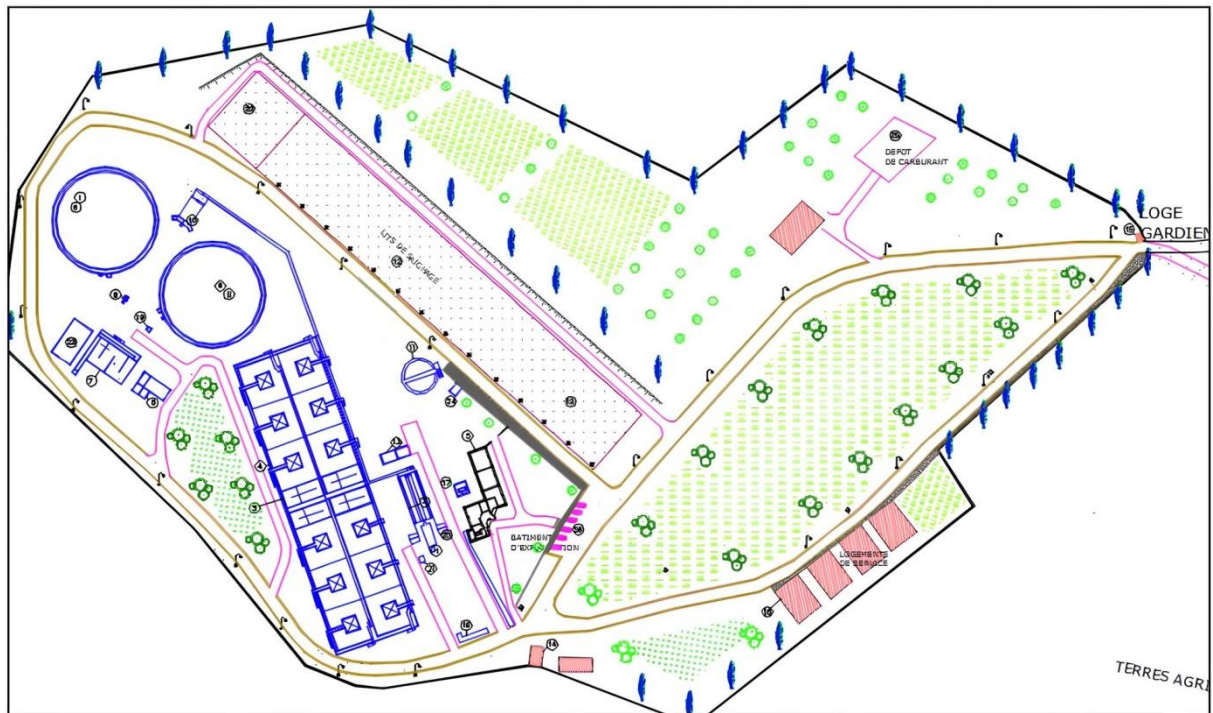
Le plan de la STEP d'Ain El Houtz (ONA, 2024).
